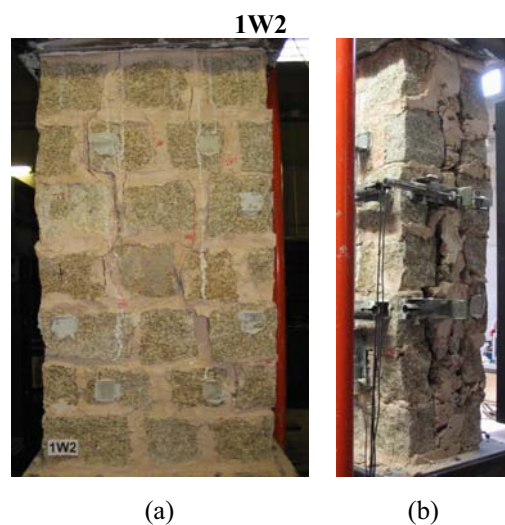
Padrão de fendilhação da parede 1W2 no final do ensaio: (a) face B; (b) face C.
